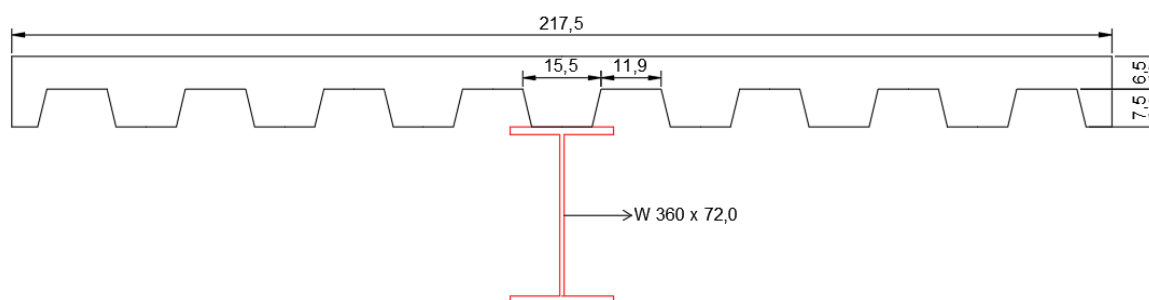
Seção transversal da viga mista de 8,7 metros.
